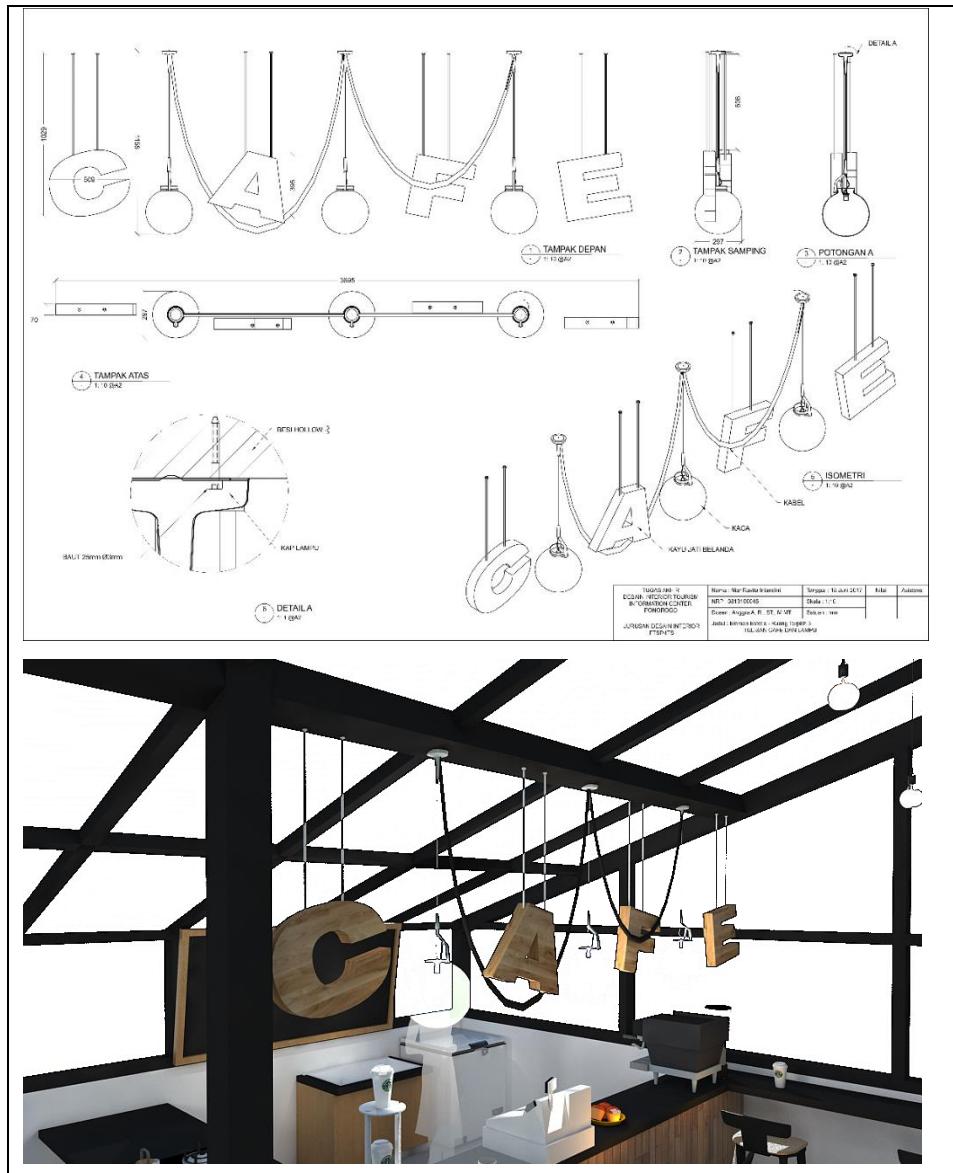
Detail Furniture 1 Ruang Terpilih 3
